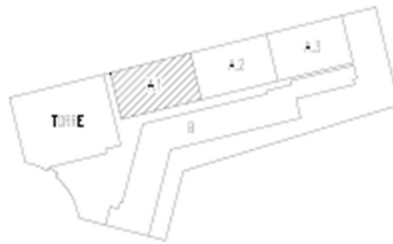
Esquema de los bloques del proyecto de nueva planta
